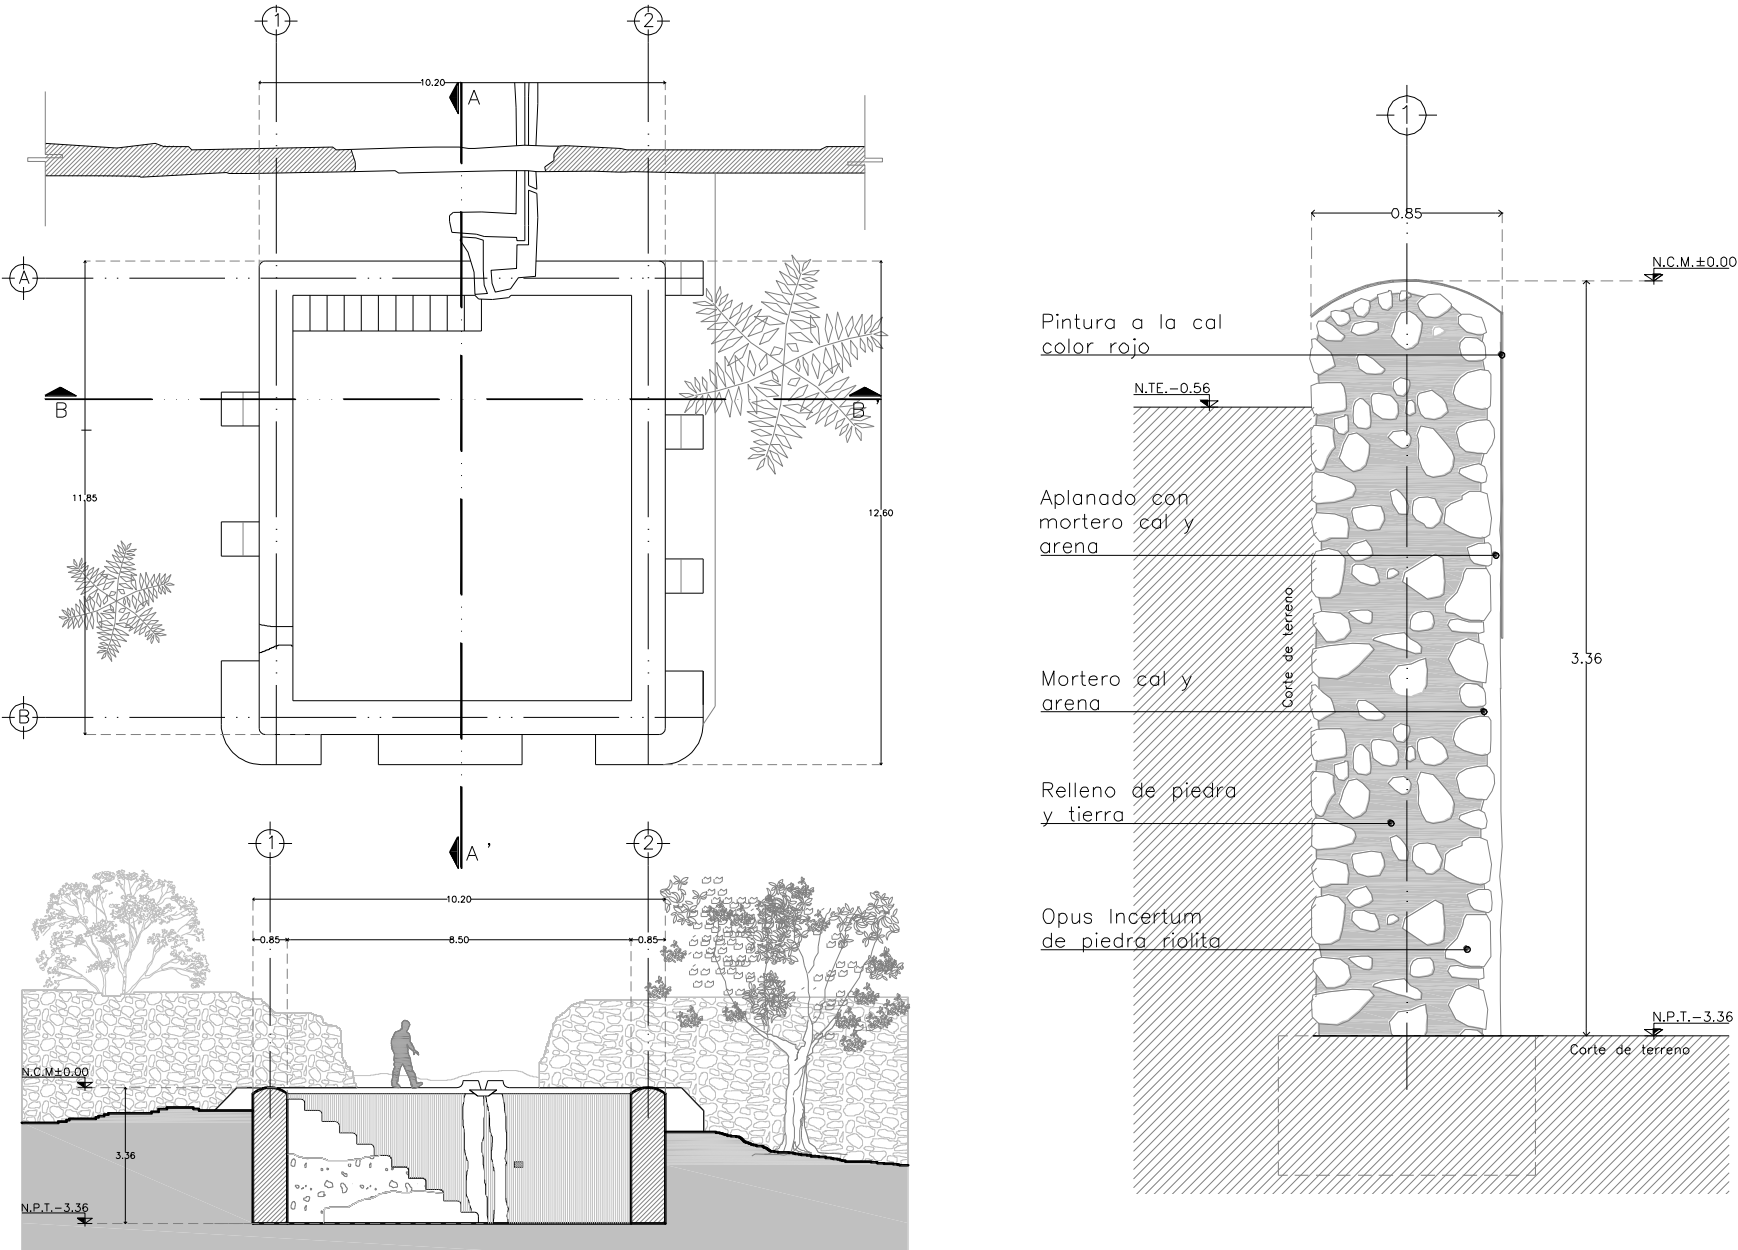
Estado actual del aljibe. Dibujos arquitectónicos: planta, sección y detalle. Ver Plano en Anexo de planos EA_010. 2017.
